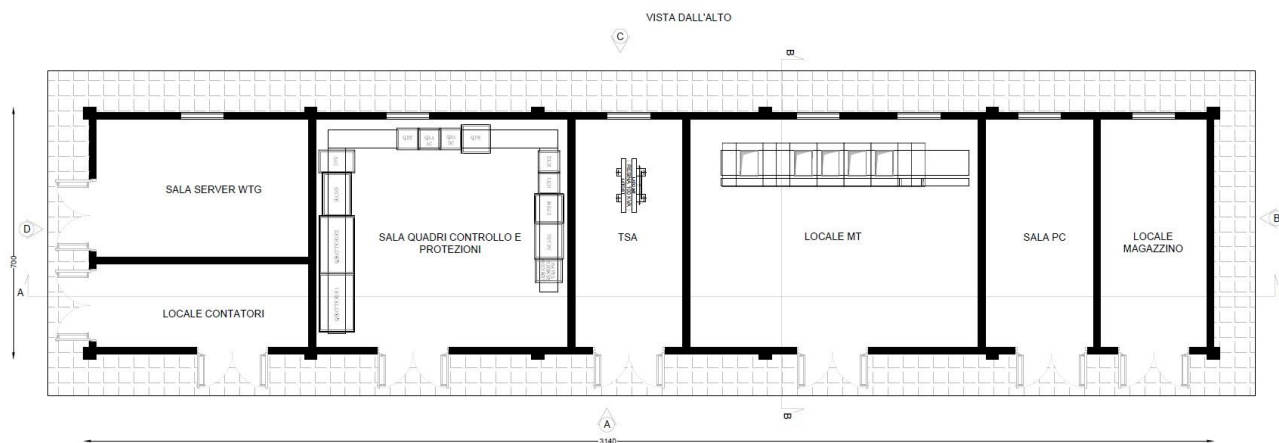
Planimetria fabbricato stazione di utenza (misure in cm)
